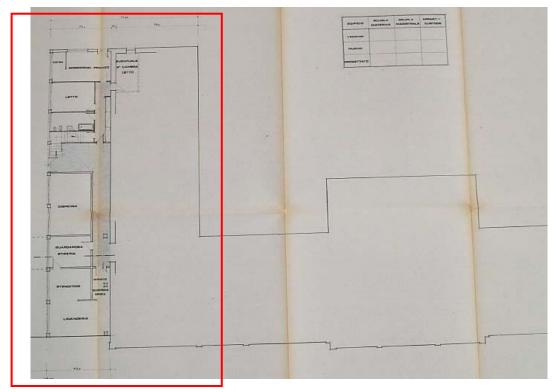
Piano seminterrato – ampliamento/sopraelevazione Blocco B
